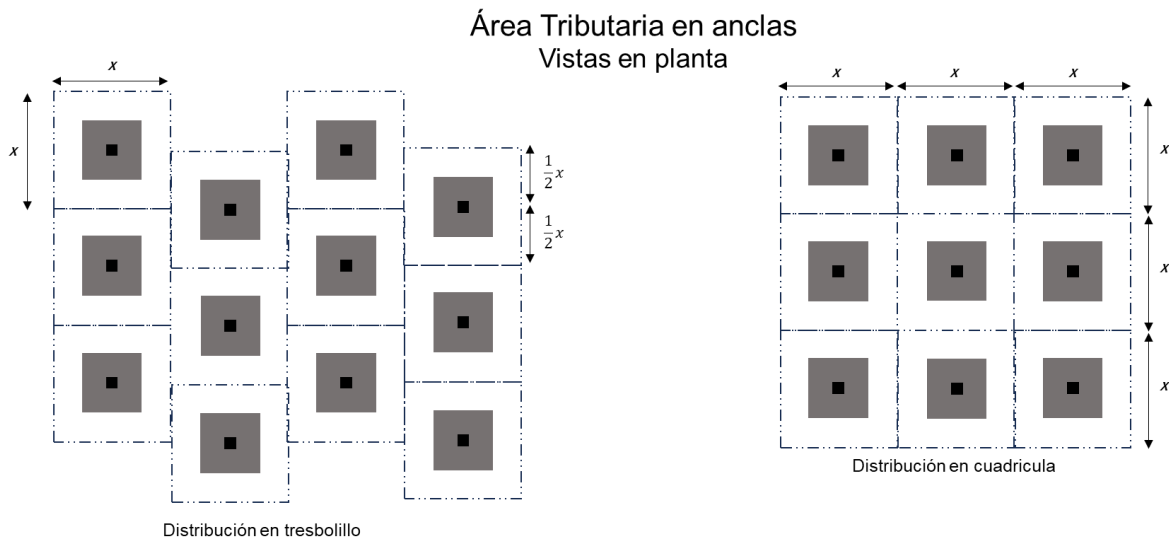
Plantillas de anclaje, plantilla a tresbolillo (derecha) utilizada en Minera Tizapa.
